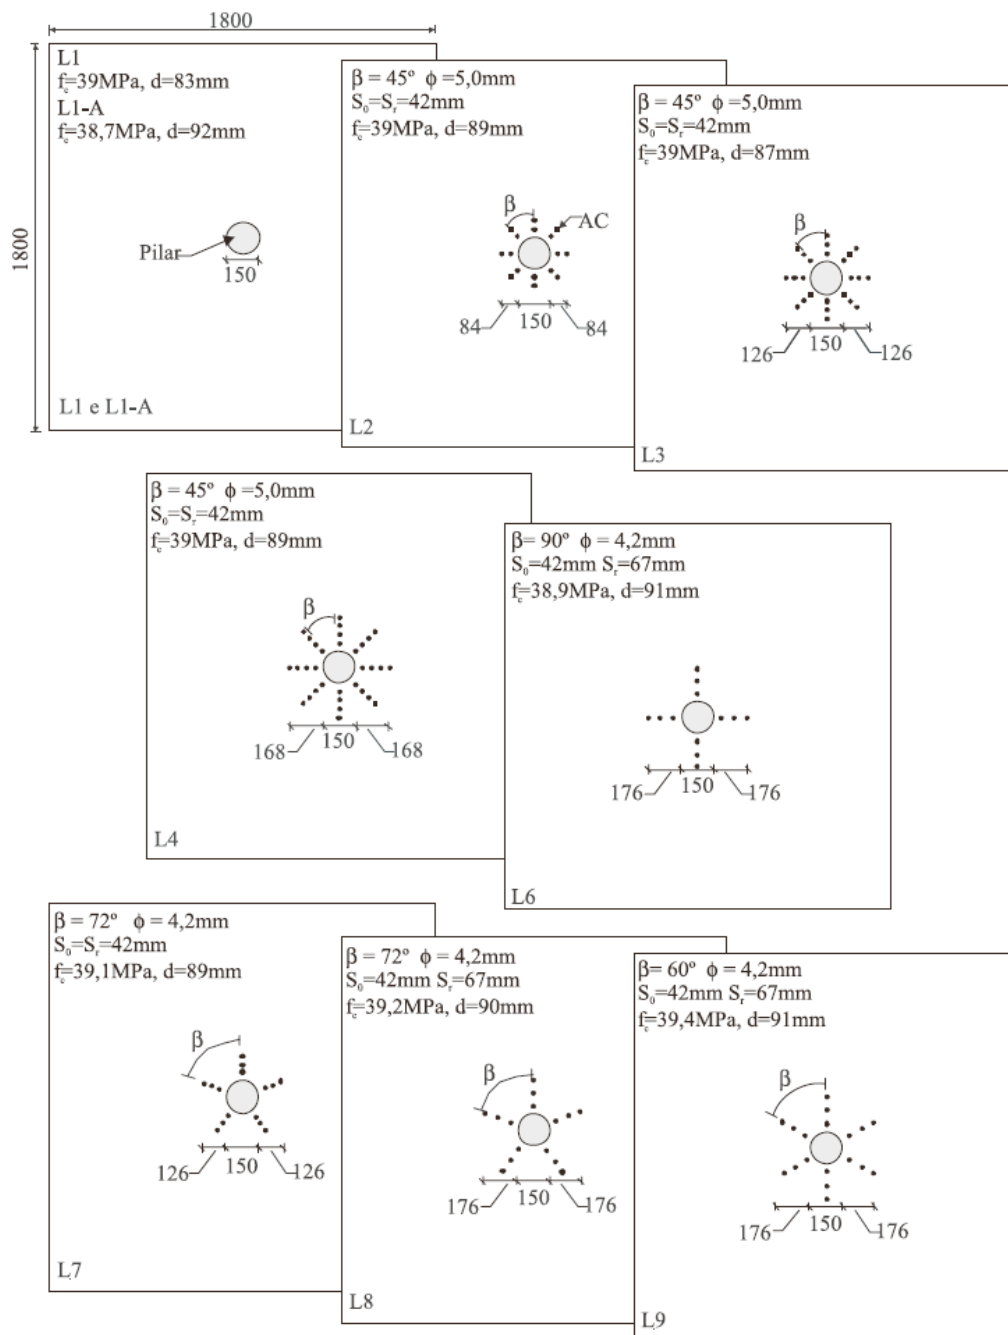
Características das lajes ensaiadas – Vaz (2009)
